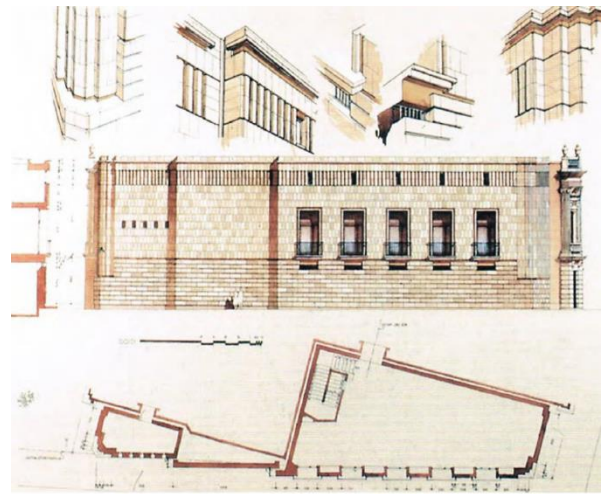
Planta, alzado y detalles hechos en acuarela de la ampliación al museo San Carlos.
